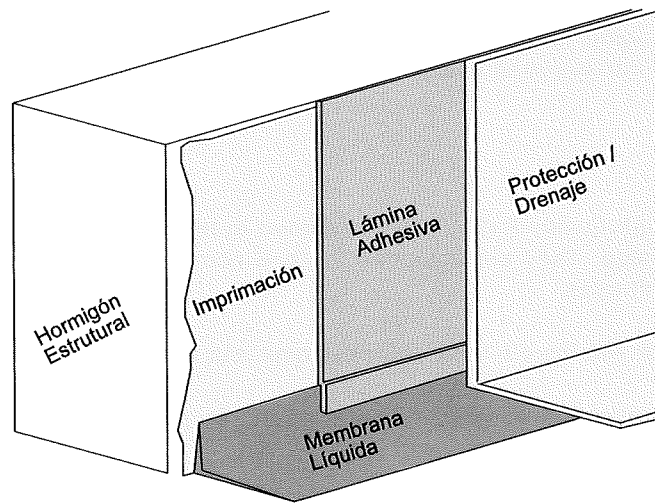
Sección tipo de aplicación de láminas adhesivas adheridas a paramentos estructurales
